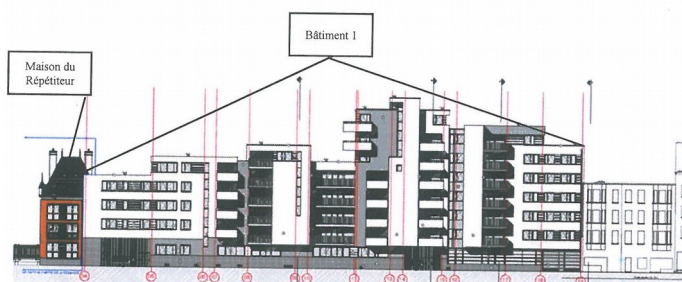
Illustration de la cohérence entre les gabarits du bâtiment 1 et de la « Maison du Répétiteur » (Façade rue du Docteur Kuborn) (ARIES sur fond de plan Accarain-Bouillot, (2016))
